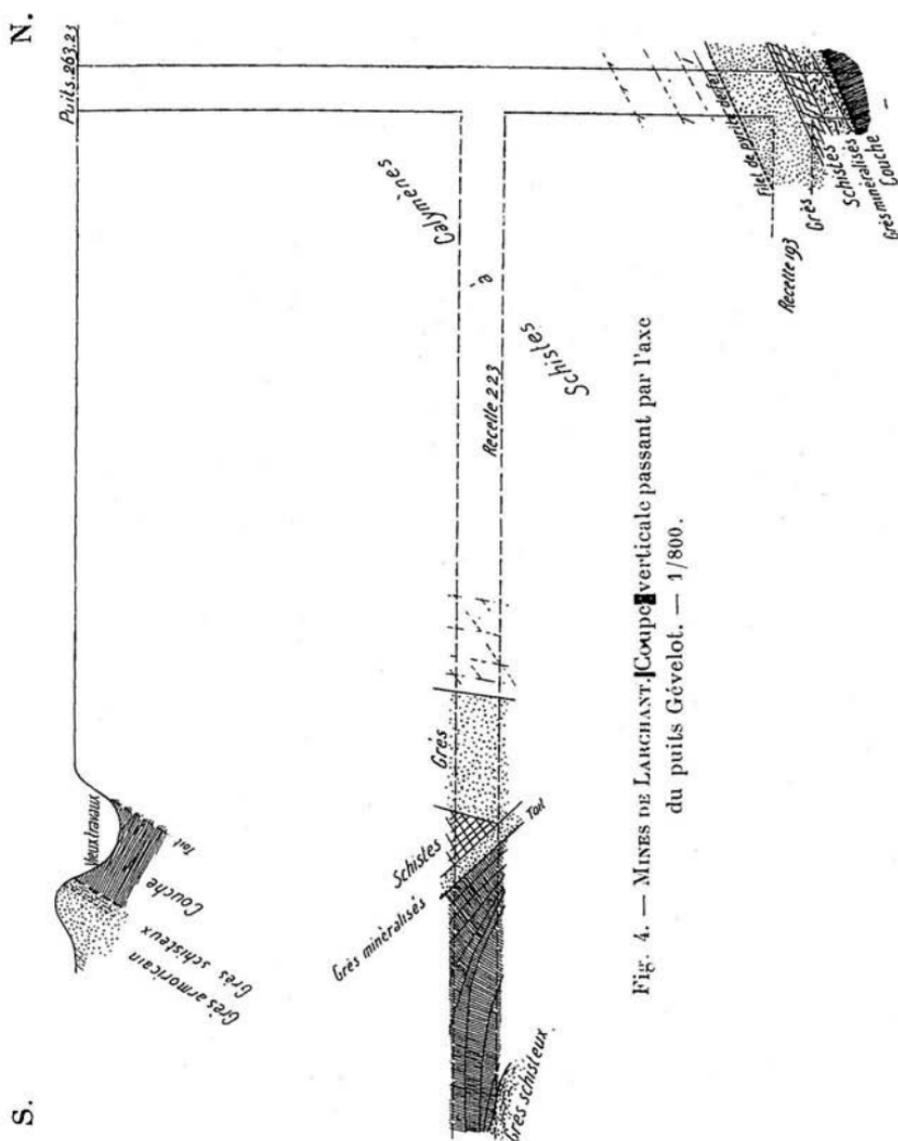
MINES DE LARCHANT. Coupe verticale passant par l'axe du puits Gévelot. — 1/800.
